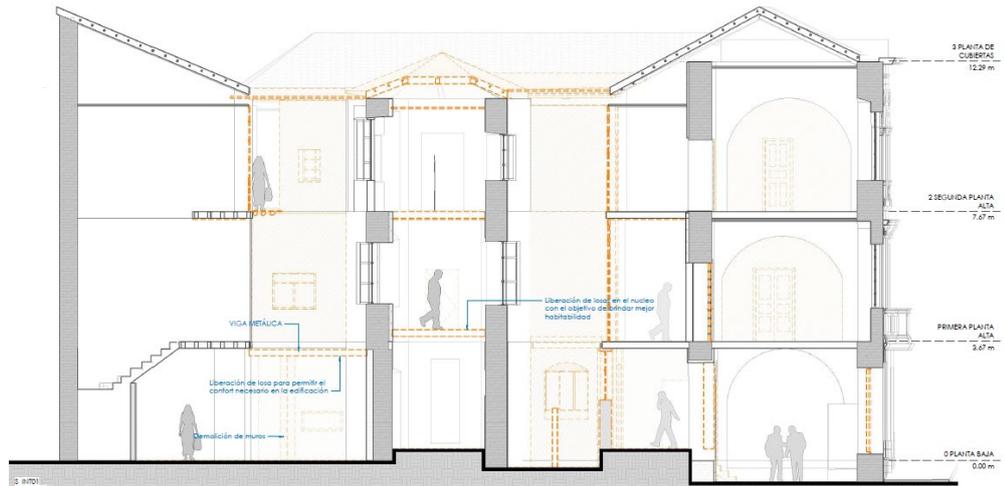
Liberaciones: planta baja, primera planta alta y segunda planta alta vistas en sección.
